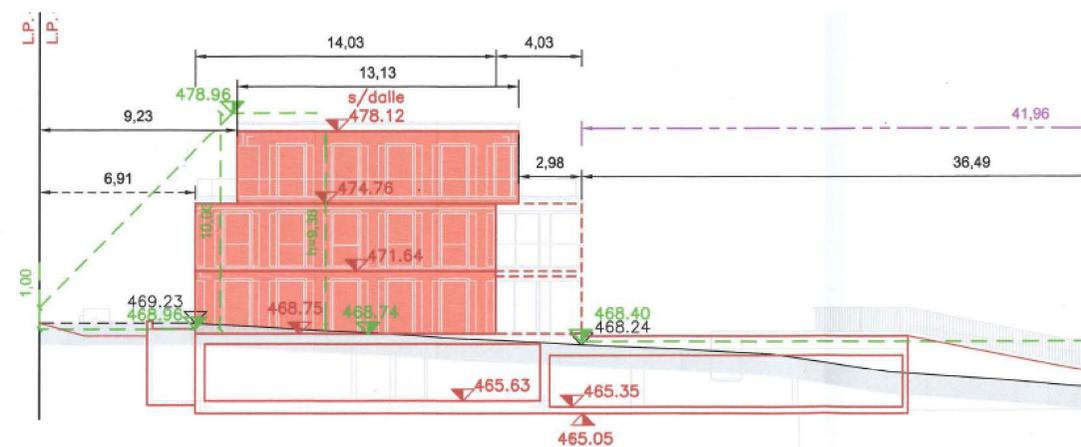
La disposition 6.11 vise à éviter des constructions souterraines sous les jardins (source : urbaplan)
